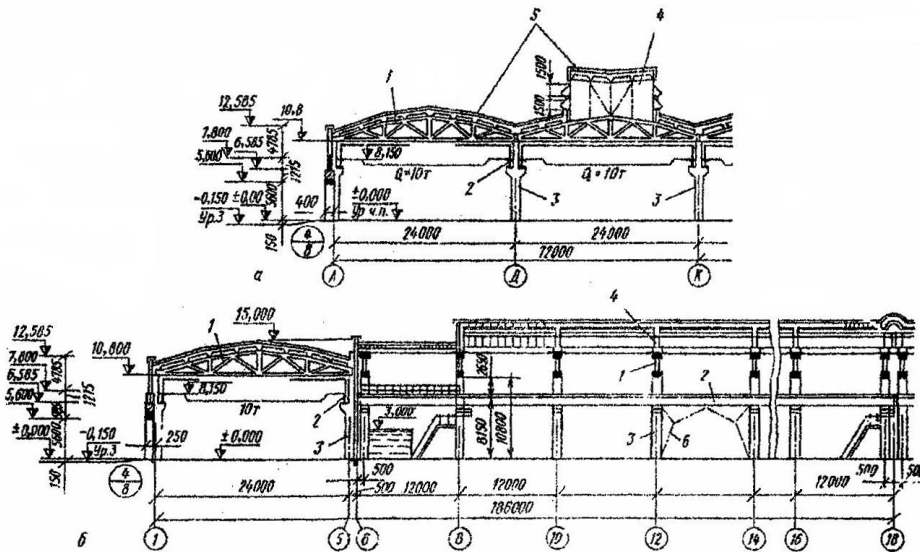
графічне оформлення каркасної одноповерхової промислової будівлі: а – поперечний розріз; б-подовжній розріз; 1 - складальні залізобетонні ферми; 2 - сталеві підкранові балки; 3 - збірні залізобетонні колони; 4 – сталева рама ліхтаря; 5 - водоізолююче покриття (асфальт 20, пінобетон 90, збірні залізобетонні плити); 6 – сталеві вертикальні зв'язки.
